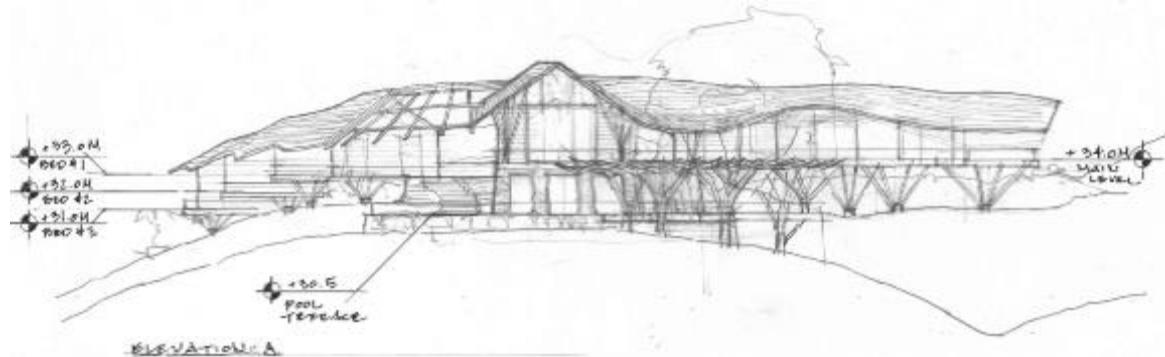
Planta A. Fuente: Planos de anteproyecto
